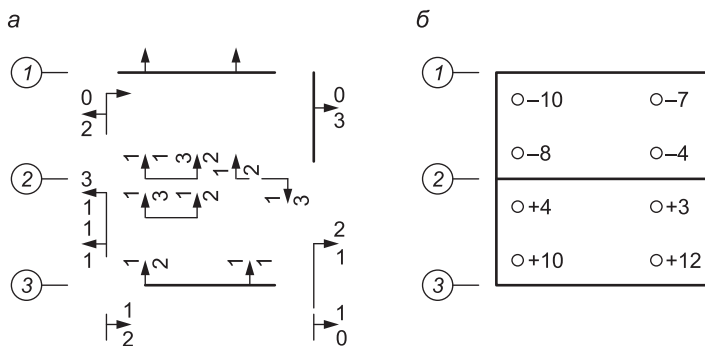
Исполнительная схема плано-высотного положения конструкций цокольного этажа крупнопанельного здания:
